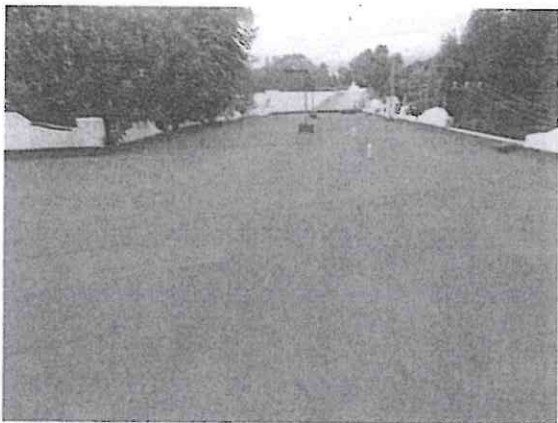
y 14. Losas de azotea del conjunto, en buen estado estructural.
